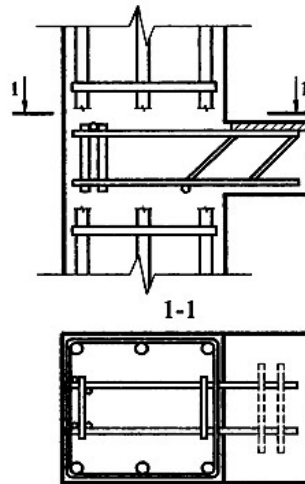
Армирование консоли колонн при шарнирном опирании ригеля
